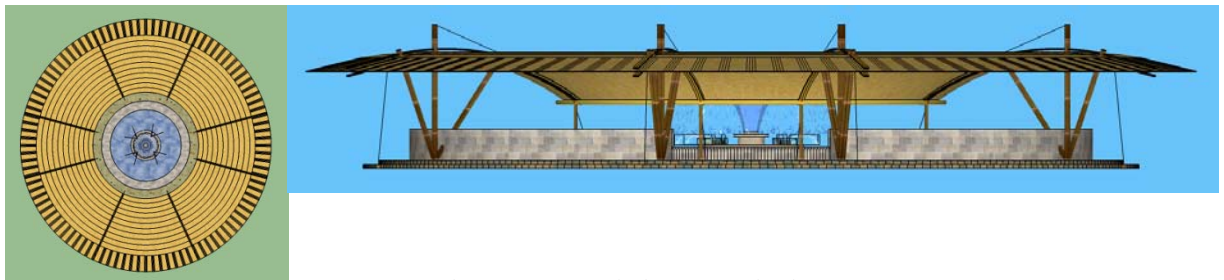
Tampak Depan Dan Belakang Ruang Penonton Lomba Burung Perkutut
